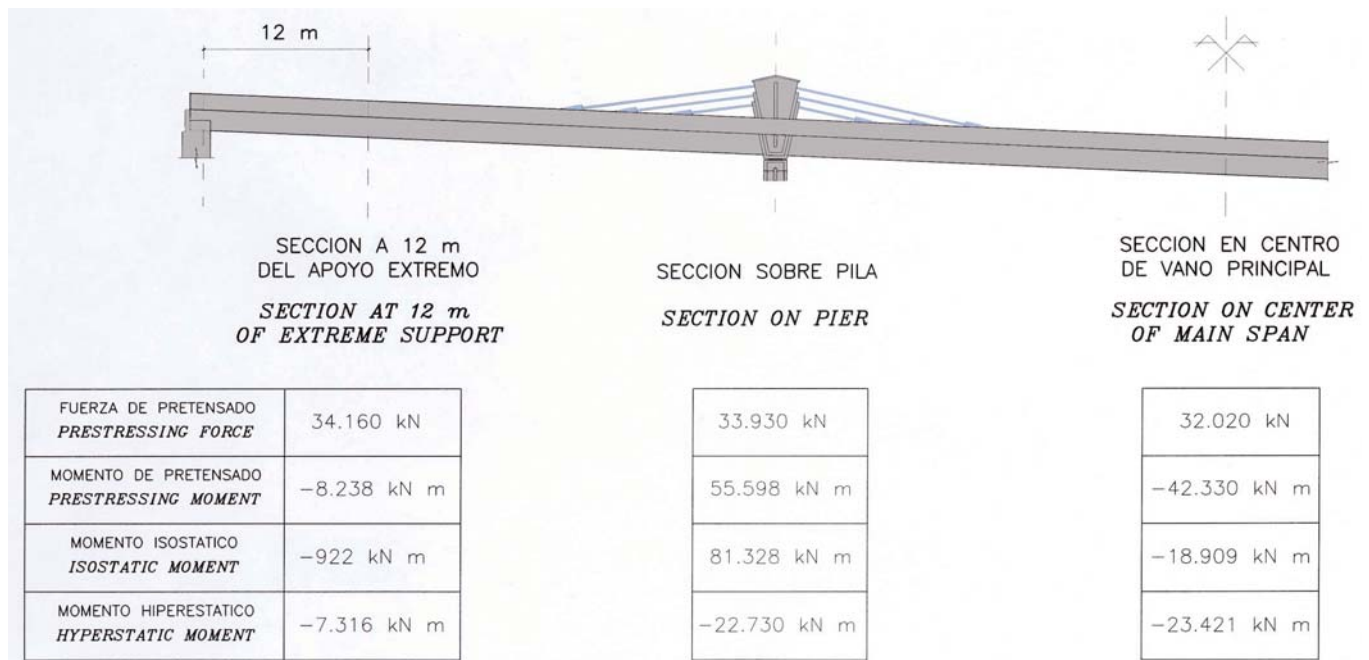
Efecto del pretensado longitudinal en el tablero.
